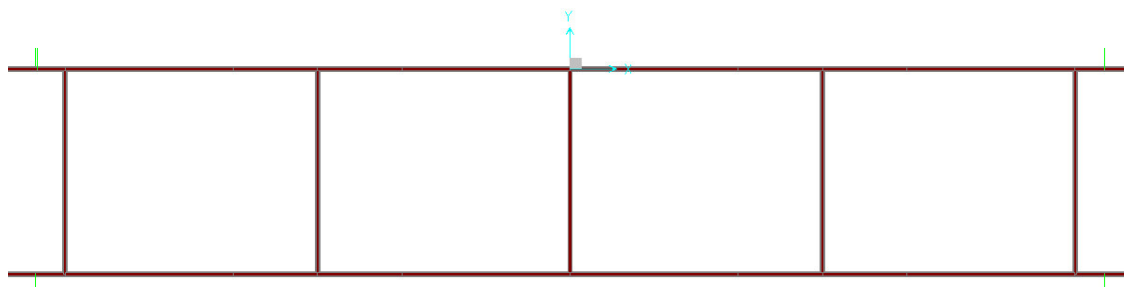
Sezione trasversale diaframma con 5 irrigidimenti
